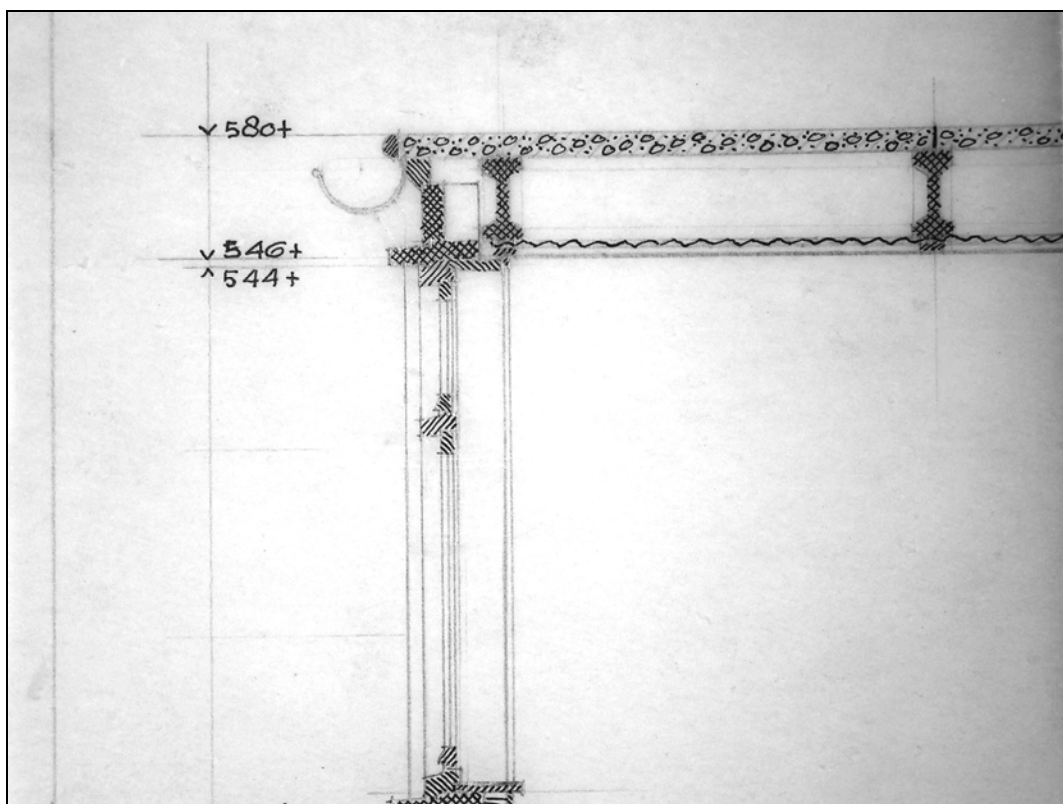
het horizontale detail en bovenaanzicht van de uitgevoerde luifel in schokbeton. NAI archief MELK, NM 3-111.
